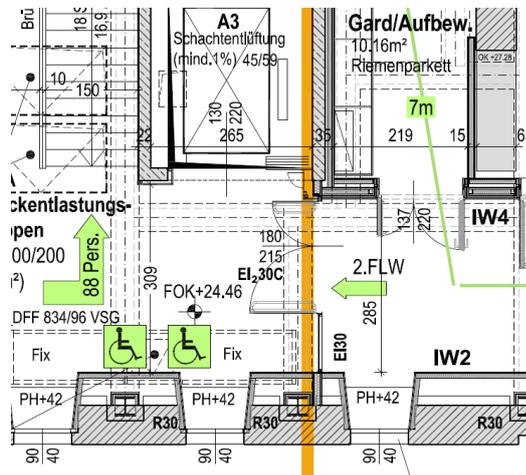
Planausschnitt Bestandsplan S0218_2
